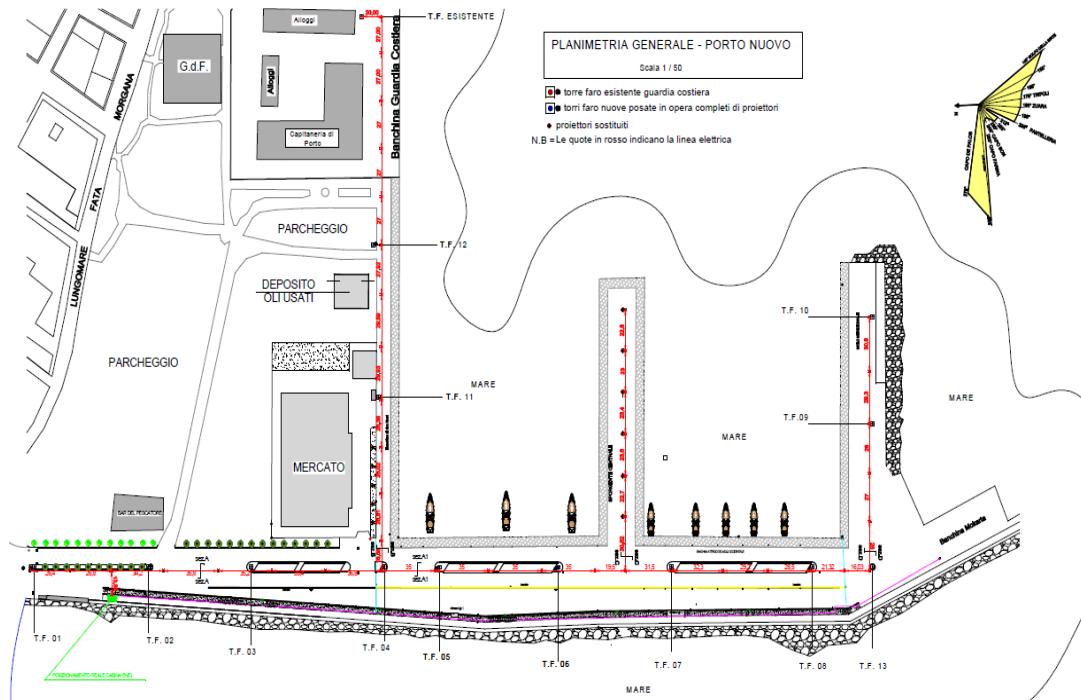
Planimetria generale con utilizzatori e linea elettrica
